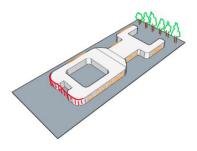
12 Perbedaan Zona pada Massa Bangunan
